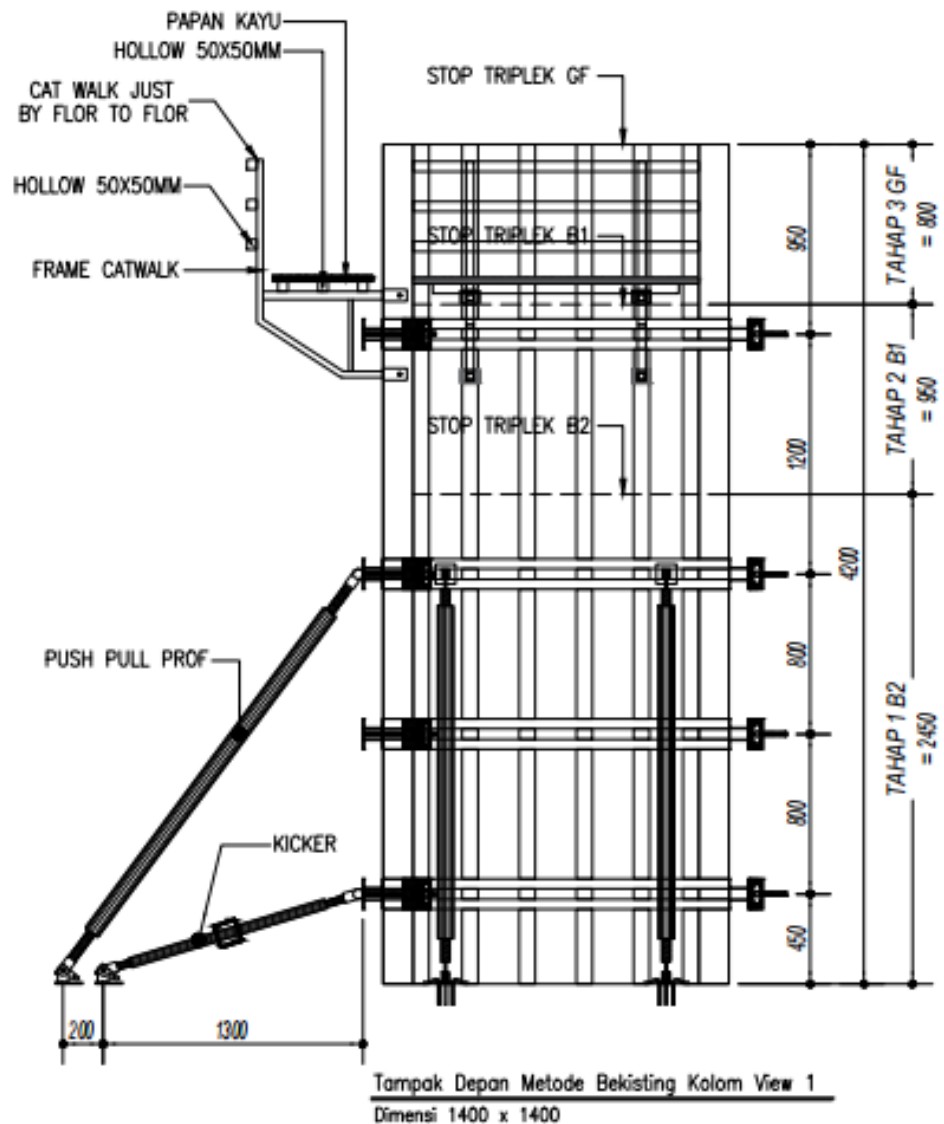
Dimensi Lebar Bekisting Kolom Semi Sistem K1, K1.A dan K1.B
